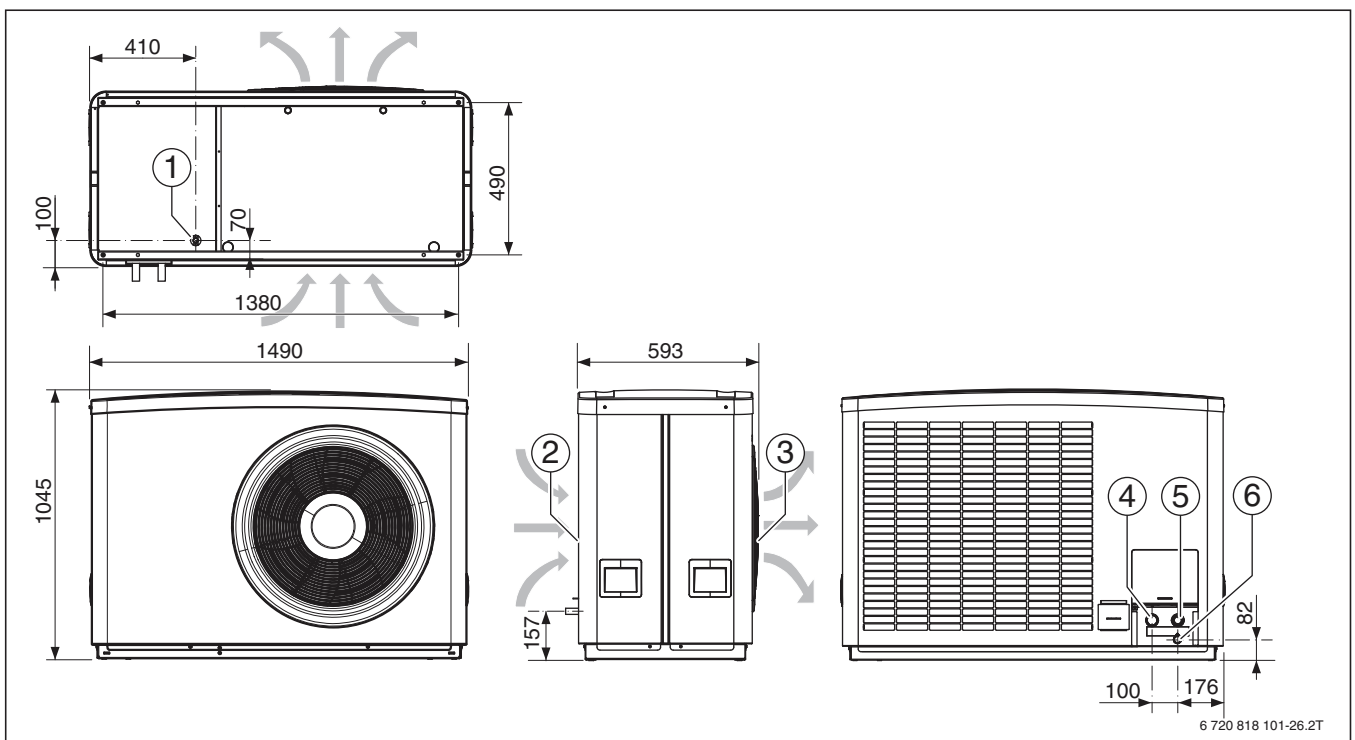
Abmessungen und Anschlüsse ODU15 HT-T
